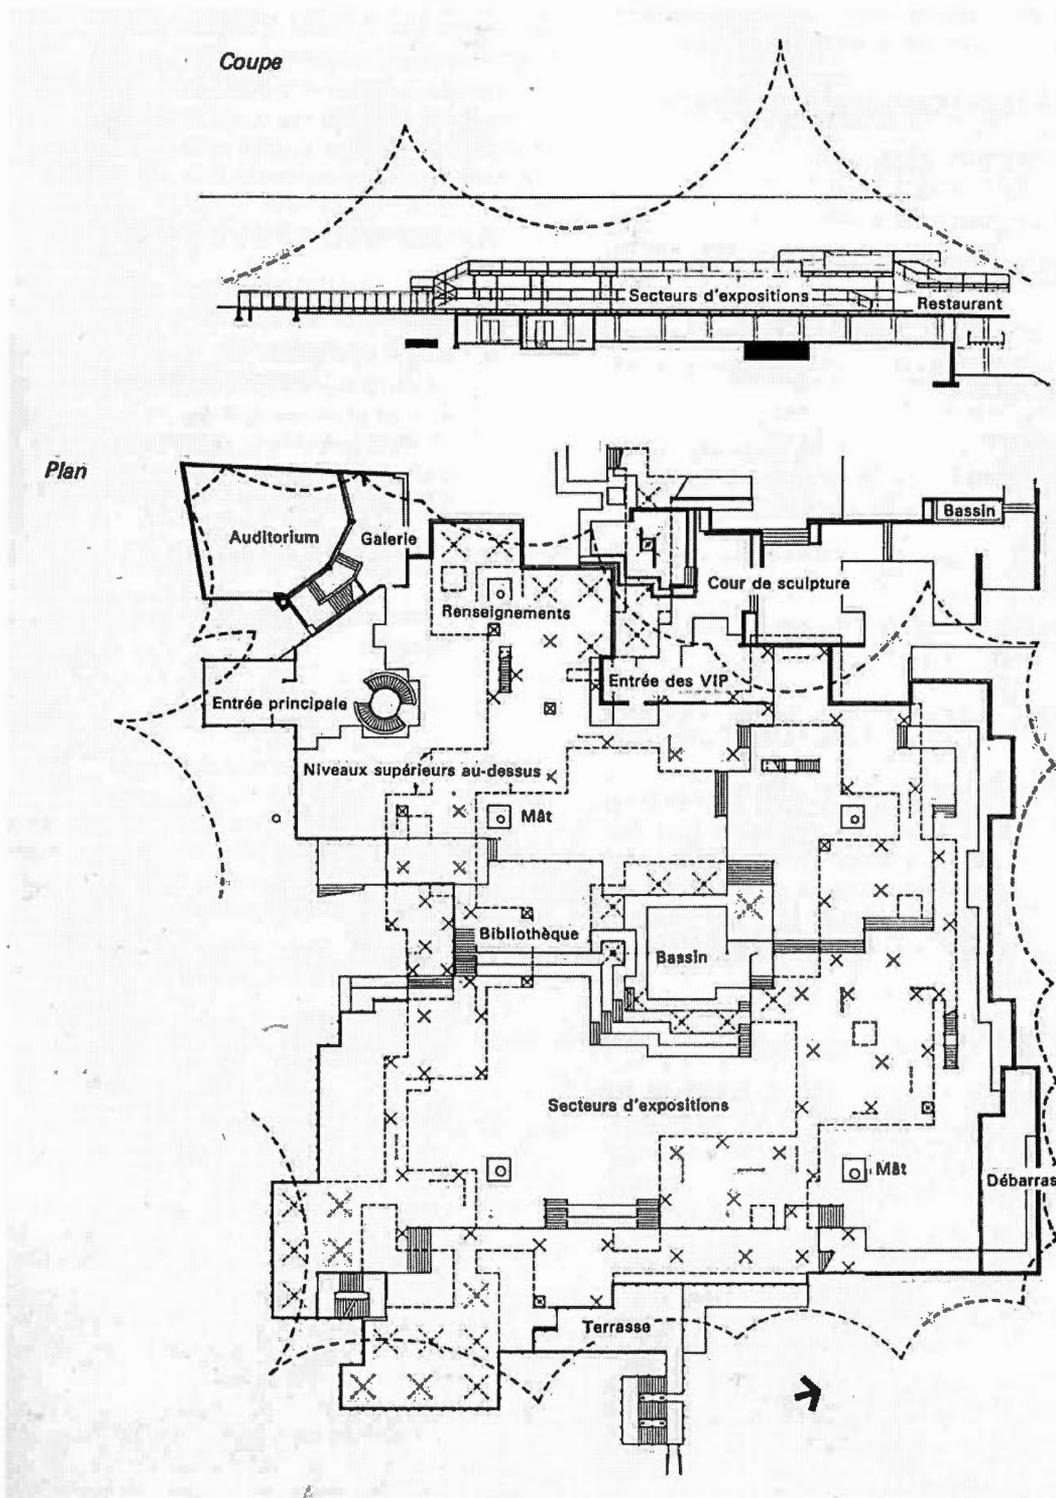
Coupe transversale et plan du rez-de-chaussée. Pavillon de la République fédérale d'Allemagne Kalin, p. 137.
